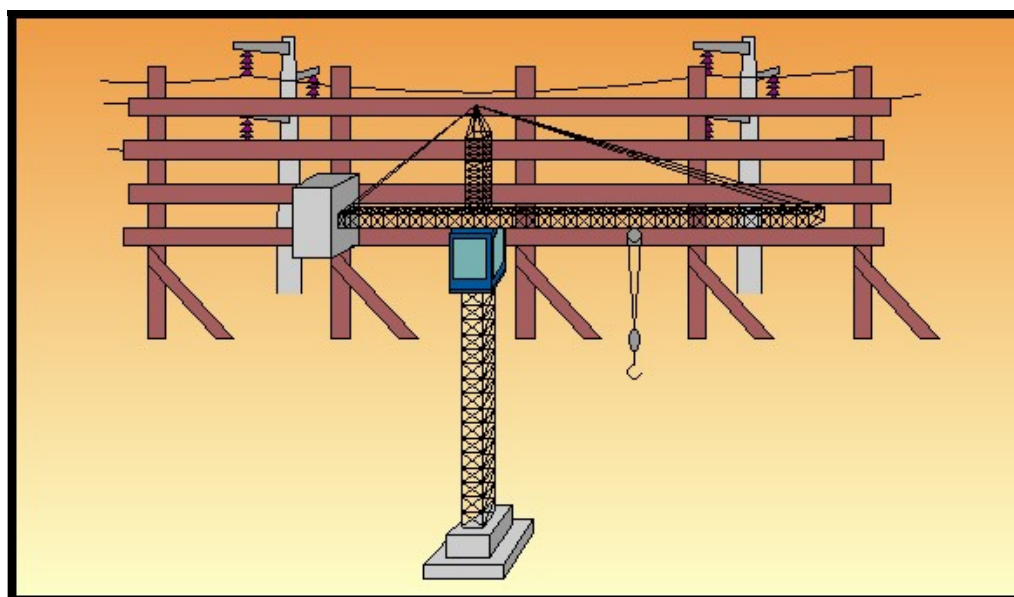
Esempio di protezione da una linea elettrica aerea in media tensione non protetta
